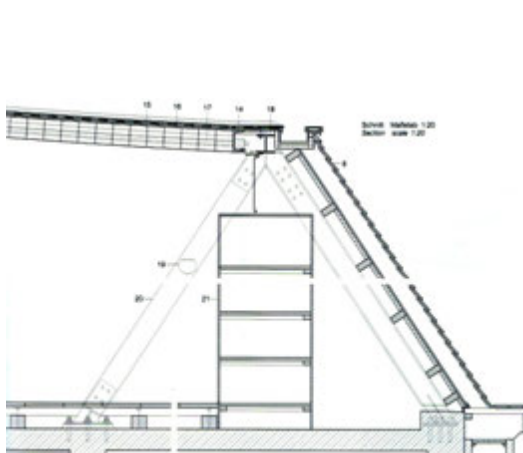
Hala recyklingu w Wiedniu. Architektura: Lukas M. Lang. Konstrukcja: J. Natterer, 1982 r. Schemat konstrukcji przekrycia dachu , [354], [357].
